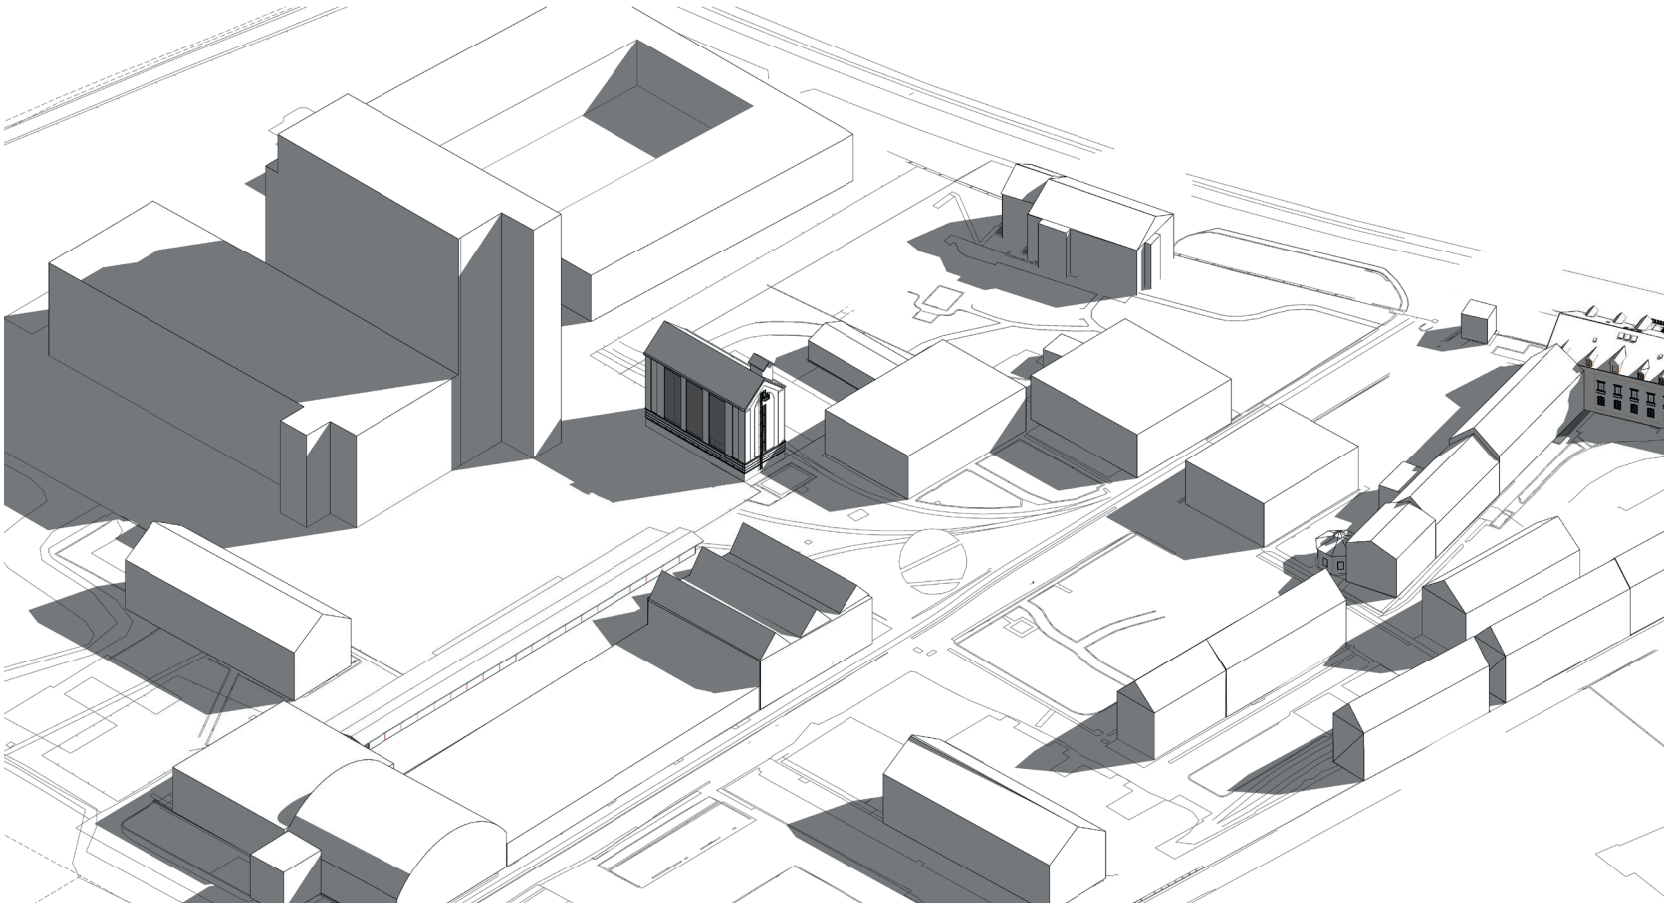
Lageplan axonometrisch Entwurf mit Ist-Zustand
